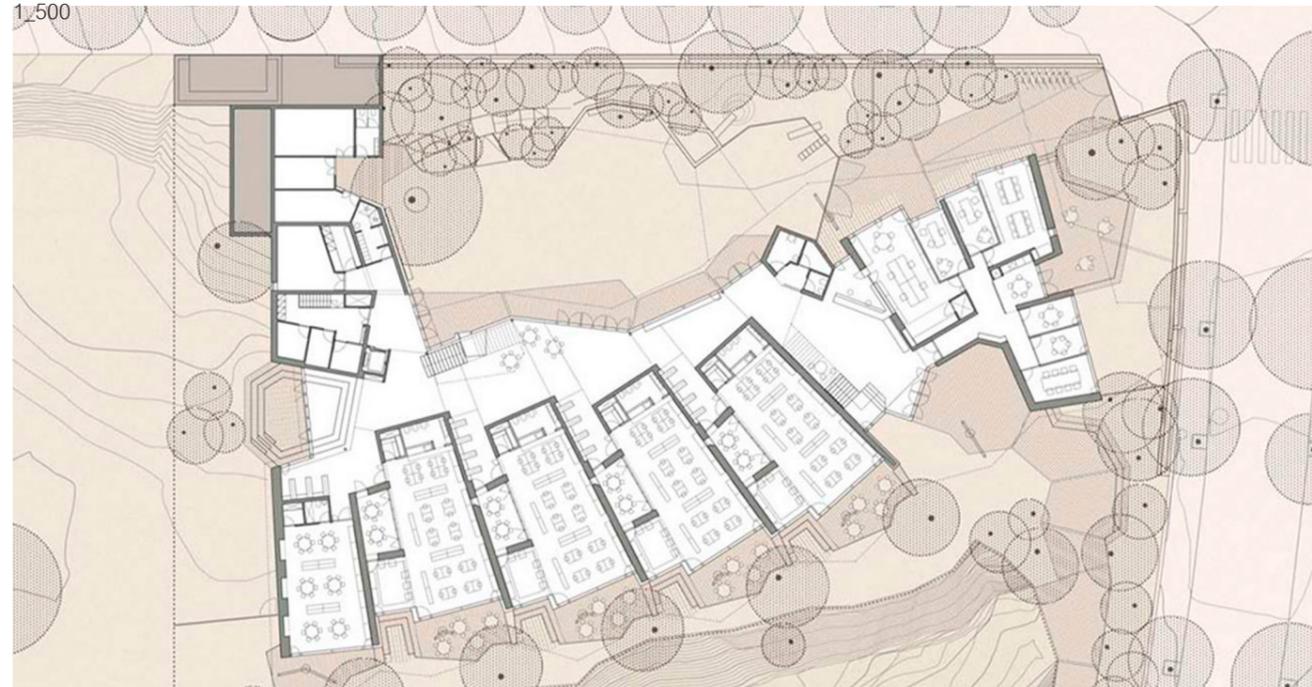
Planta baja. Imagine Montessori School. (Fase 1 + 2) E: 1_500
